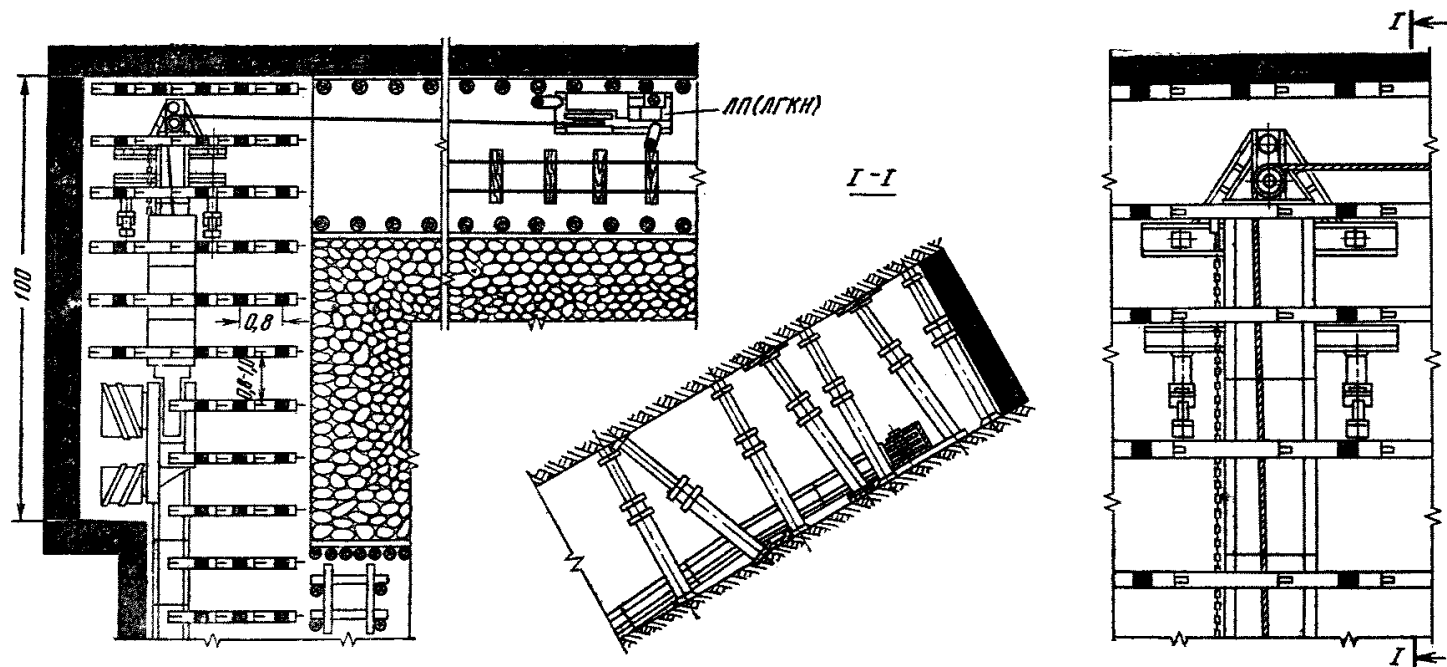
Крепление тяговой цепи комбайна и обводного блока предохранительного каната на специальной раме верхнего решета
